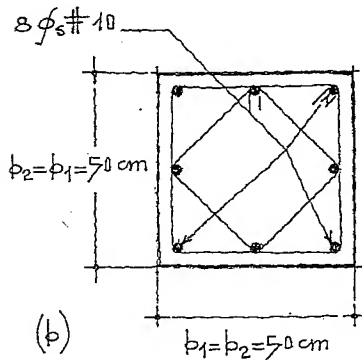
Sección transversal de la columna vista en planta, (b).
